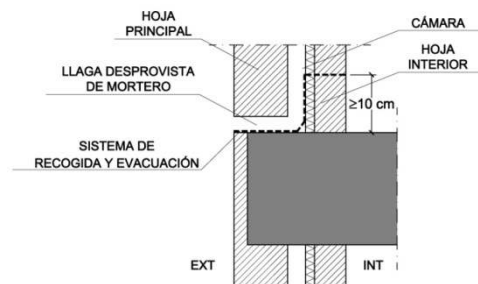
Ejemplo de encuentro de la fachada con los pilares
